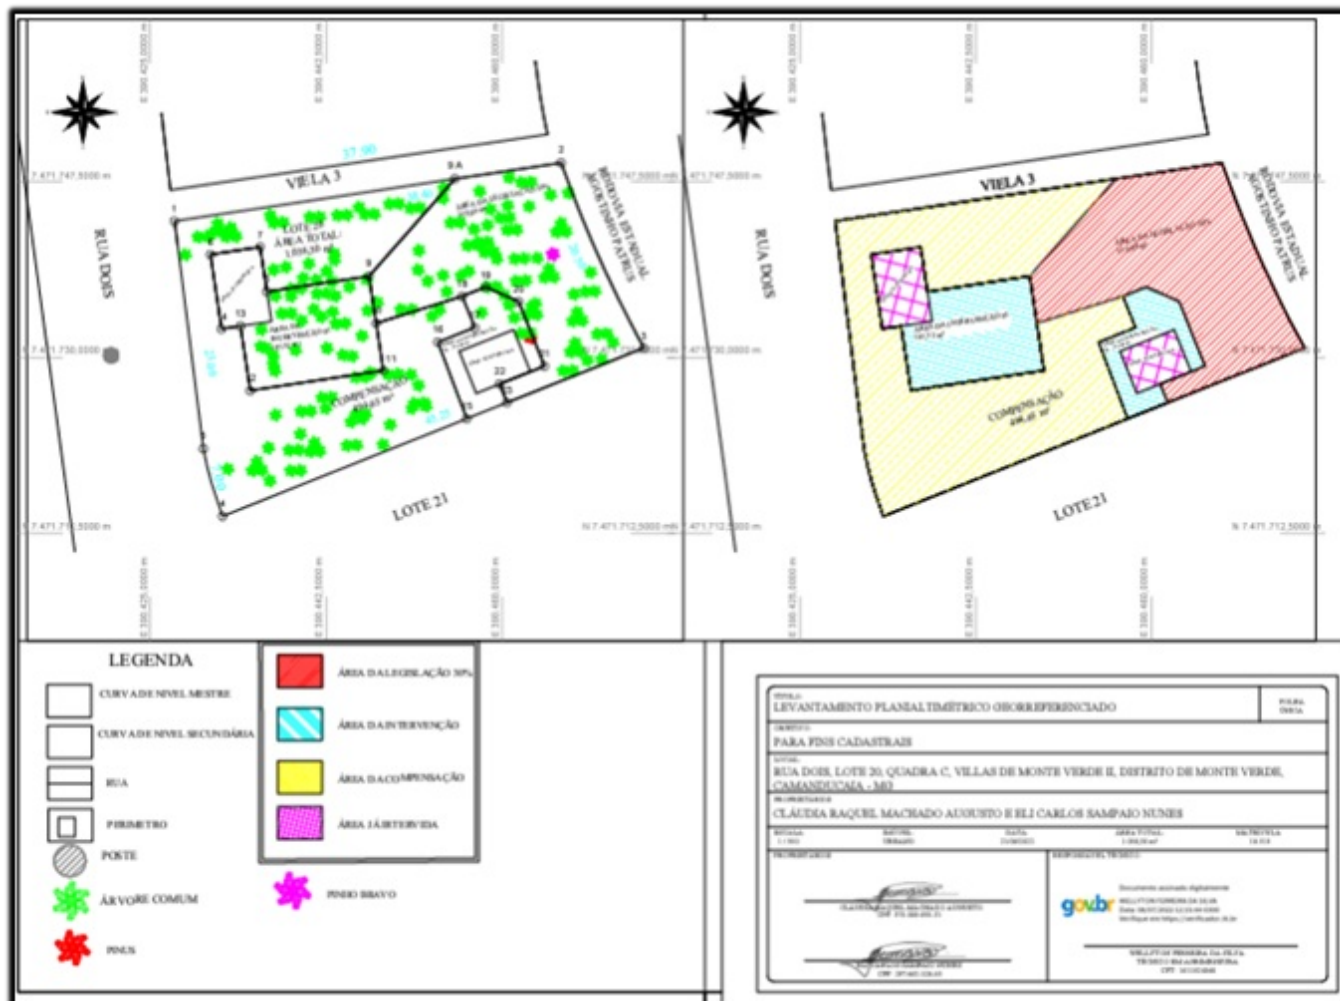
Planta planialtimétrica do Lote 20, Quadra C, situado na Rua da Pedra, Loteamento Villas de
